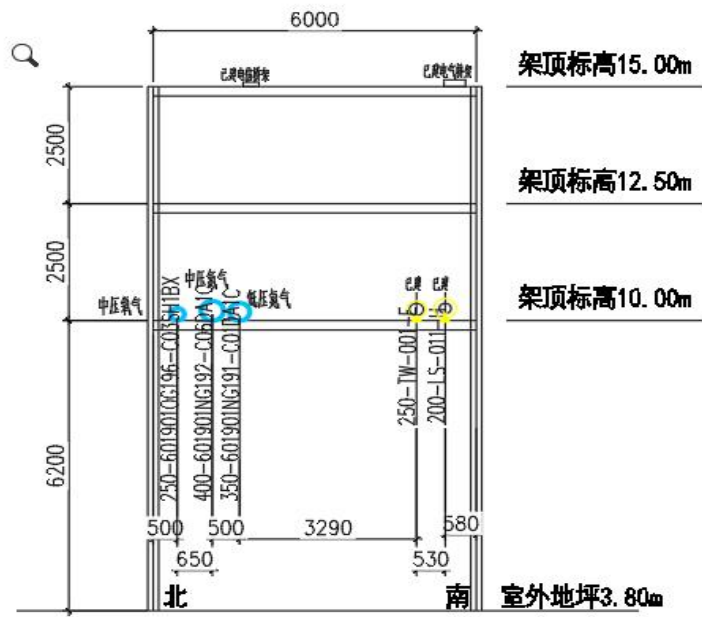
渤化发展与园区界区交接点管廊断面图
